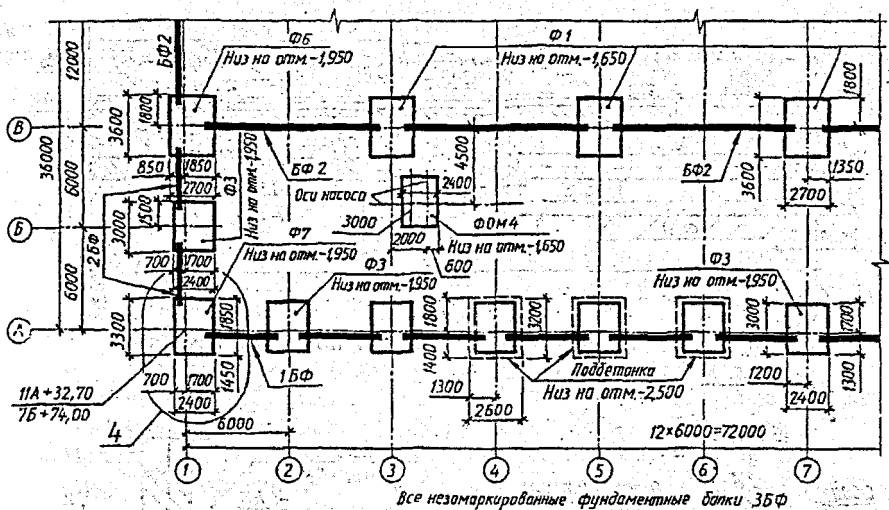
Фрагмент оформления плана фундаментов под колонны
